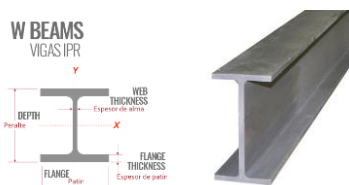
Vista de las partes que componen el perfil W (Vigas IPR).
